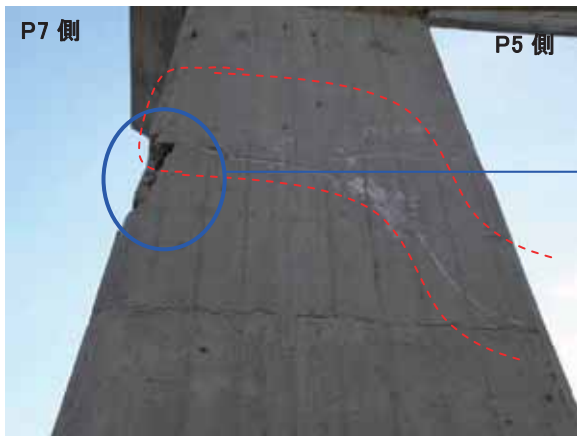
P6 橋脚下流側柱中間部 : 側面のひび割れ(上流側より)
